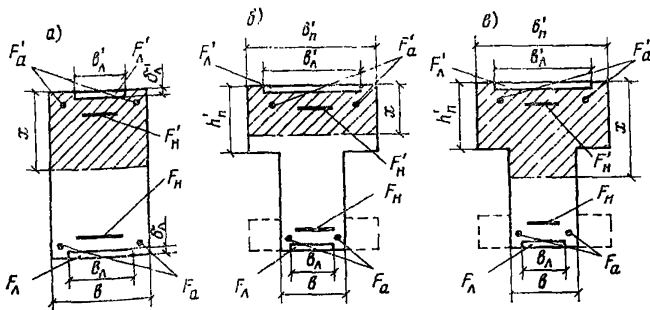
К определению сжатой зоны изгибаемых элементов с внешним армированием при различных формах поперечного сечения
